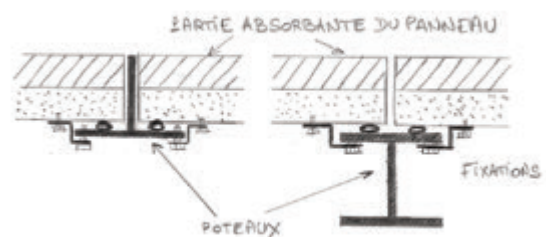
poteaux avec fixations du panneau visant à masquer le poteau coté route
